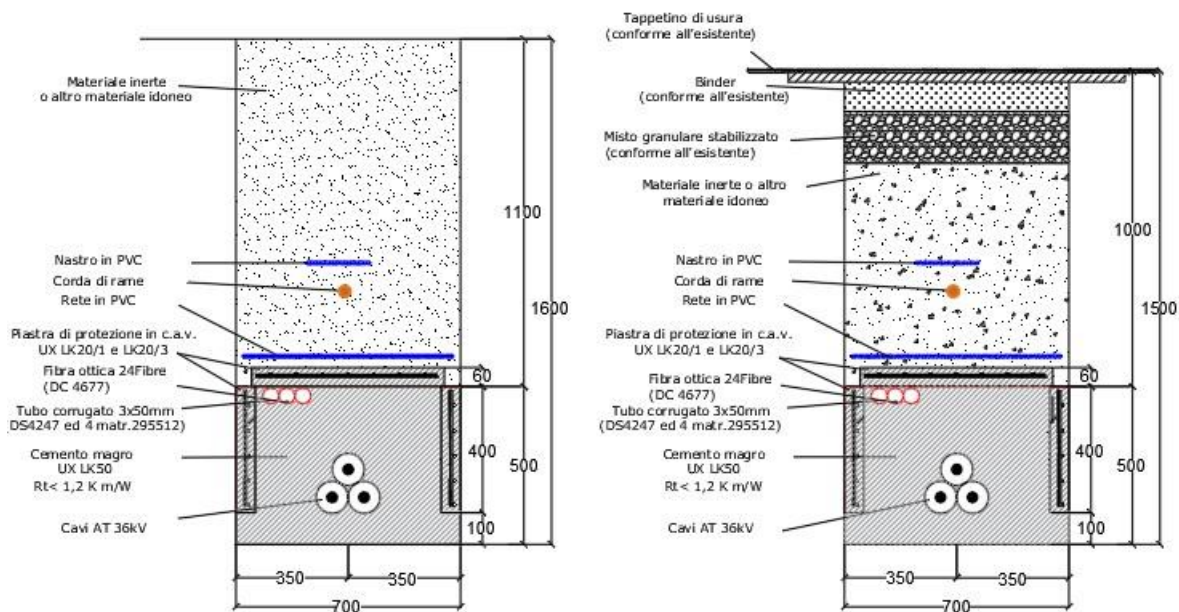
Tipico di sezione cavidotto AT su strada e su terreno agricolo
